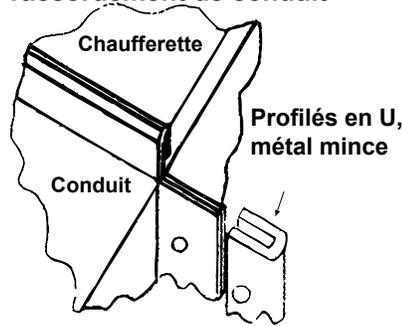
B - Installez des profilés en « U » sur les côtés du raccordement de conduit
